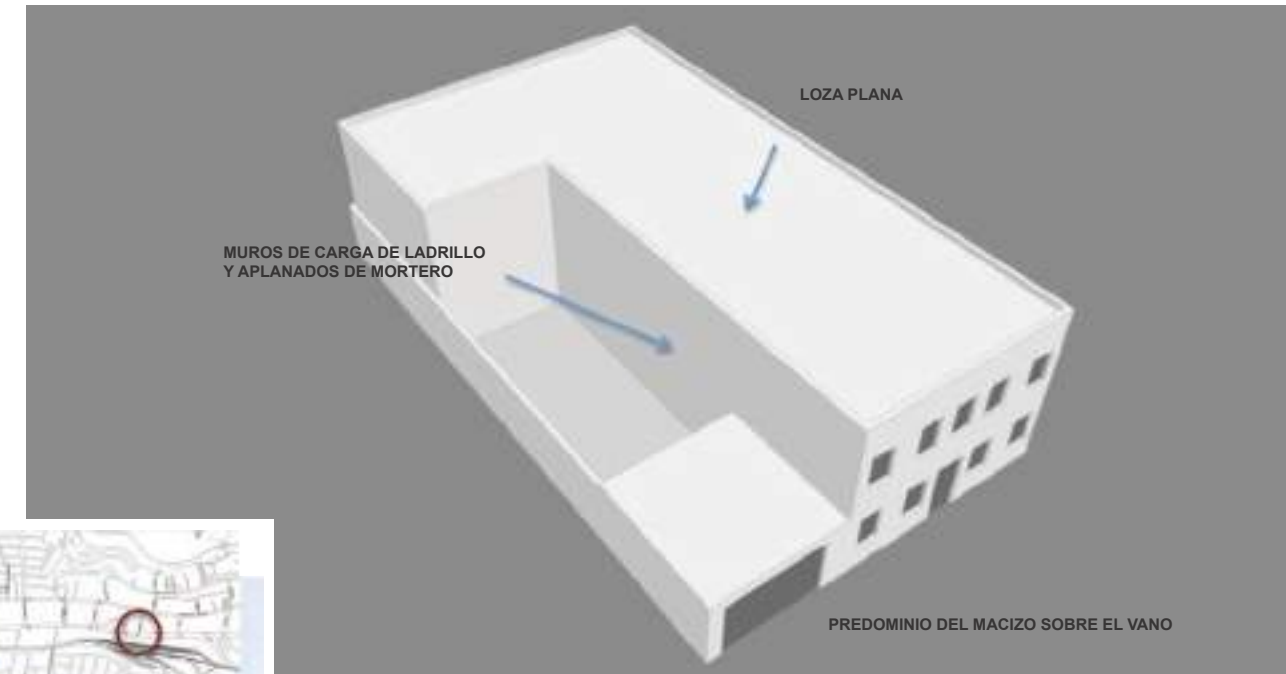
Planta Tipo I de vivienda unifamiliar en 2009.
